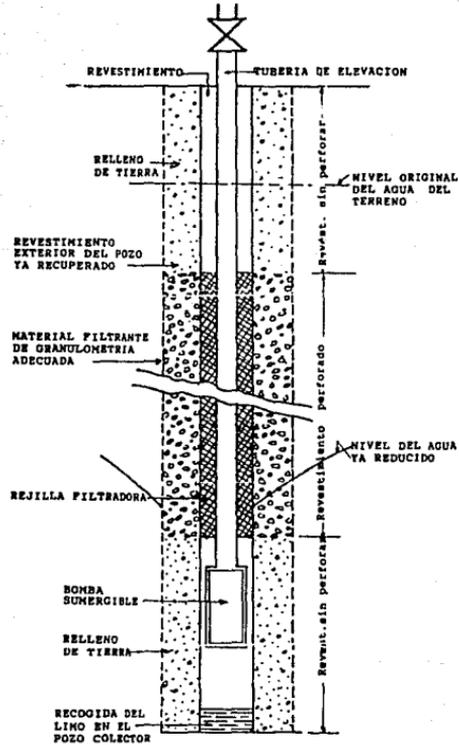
INSTALACION DE POZO PROFUNDO
